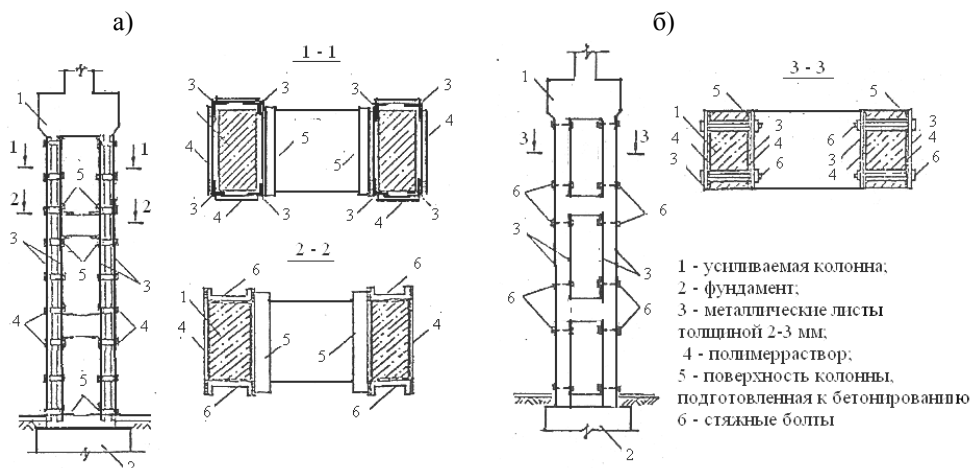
Усиление железобетонных двухветвевых колонн металлическими обоймами вокруг ветвей из уголков и швеллеров (а) и наклейкой металлических пластин (б): для (а) 1 - усиливаемая колонна; 2 - фундамент; 3 - продольные уголки обоймы; 4 - поперечные планки обоймы; 5 - поперечные планки-упоры; 6 - продольные швеллеры обоймы
